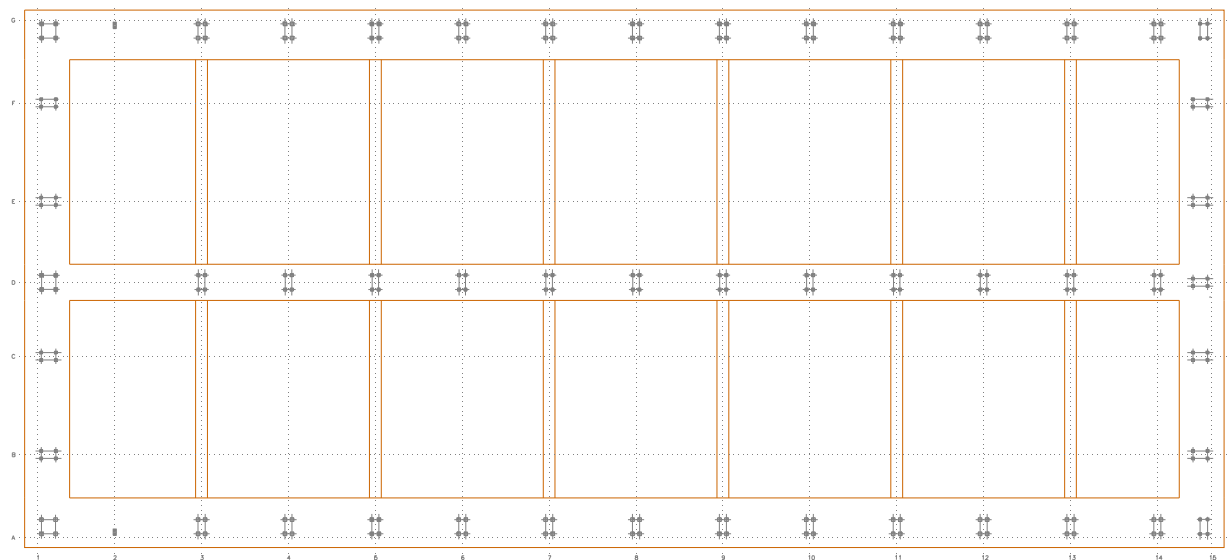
ESQUEMA EN PLANTA DE CIMENTACIÓN
